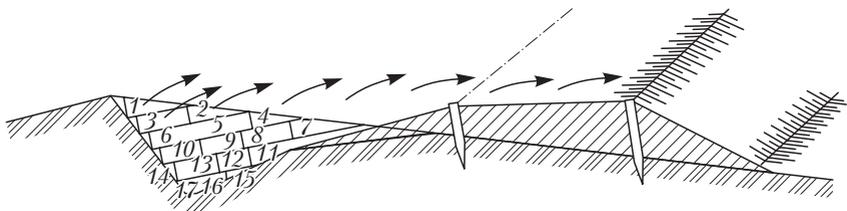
Схема перемещения грунта грейдером на косогоре (числами обозначена последовательность перемещения объемов грунта)
